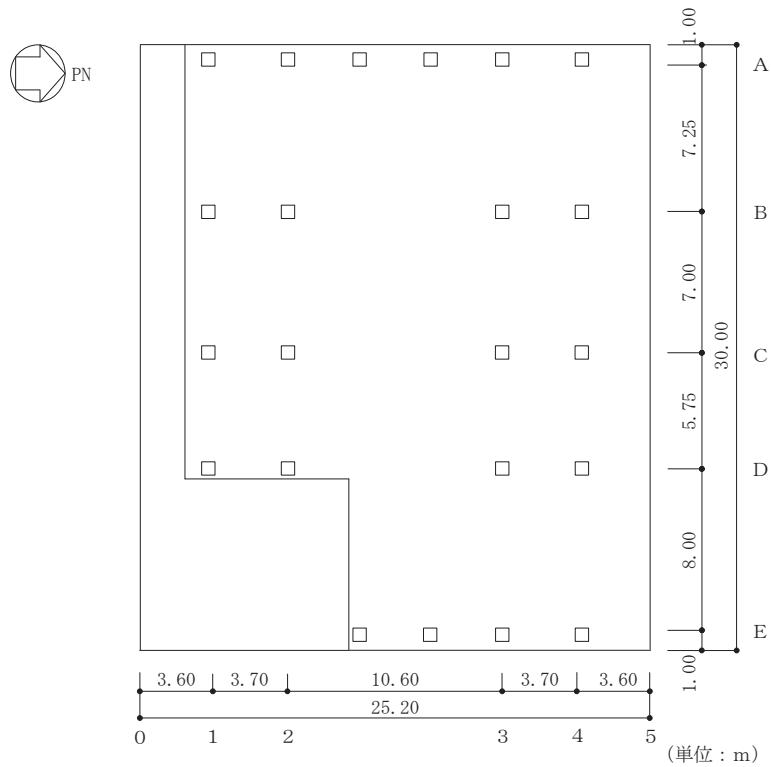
(2) 緊急用電気品建屋の概略平面図(0. P. 62. 9m)
